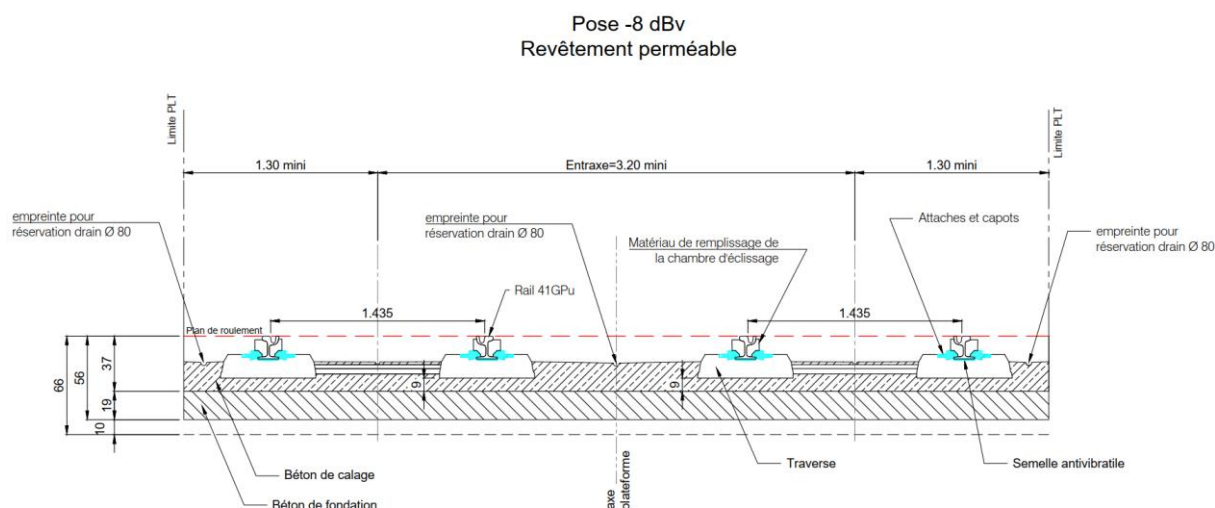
Exemple d'une coupe type d'une pose de voie avec un revêtement perméable. Source : Groupement - APS Plans
